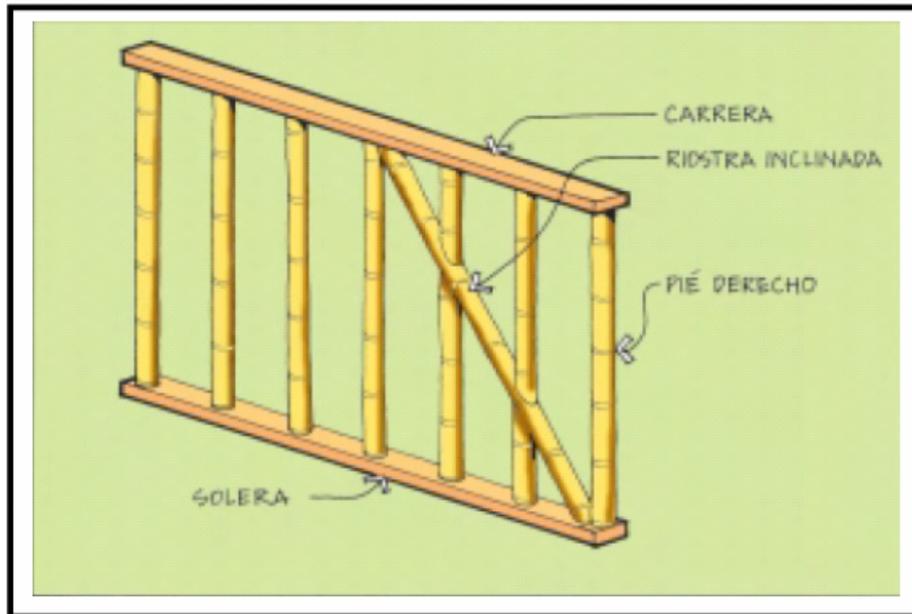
Panel estructural arriostrado. Fuente AIS
